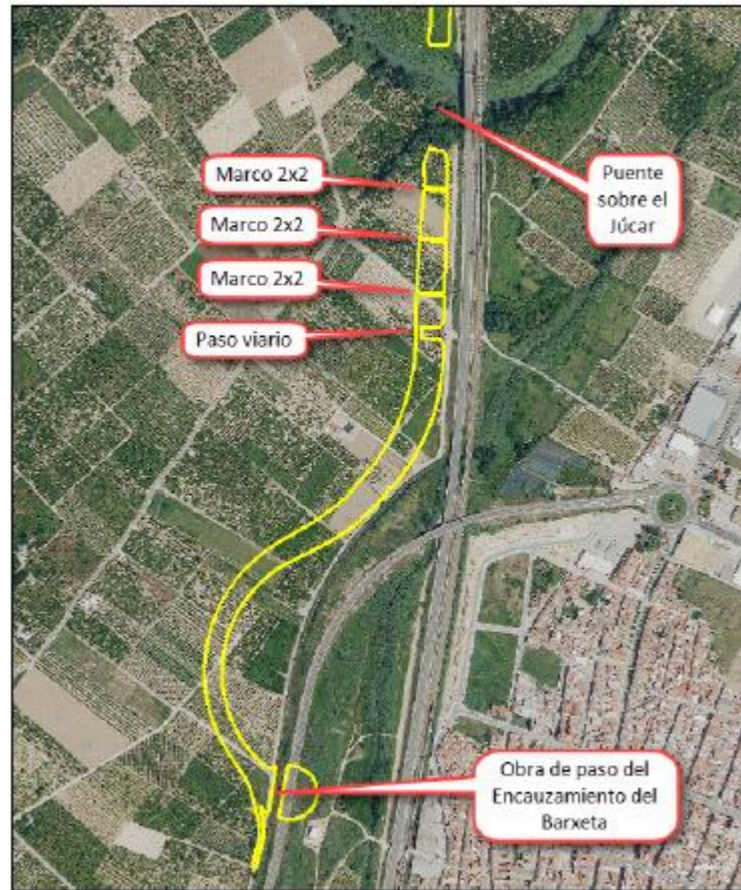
Obras de drenaje transversal previstas. Tramo Sur
